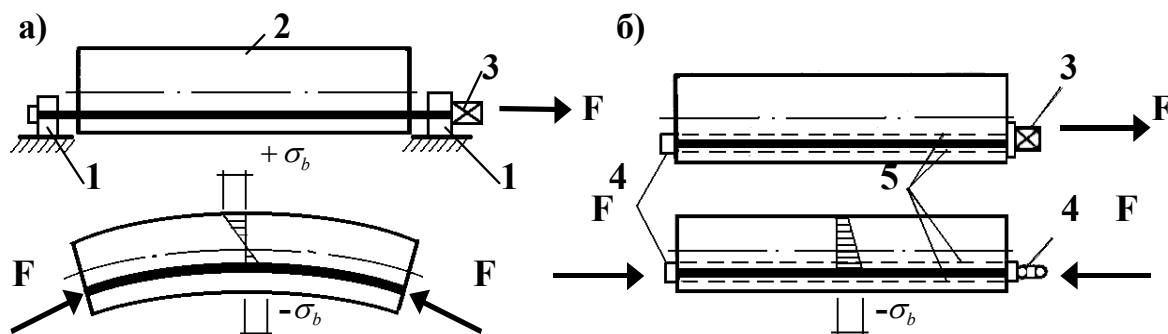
Схемы предварительного натяжения арматуры железобетонных конструкций:
